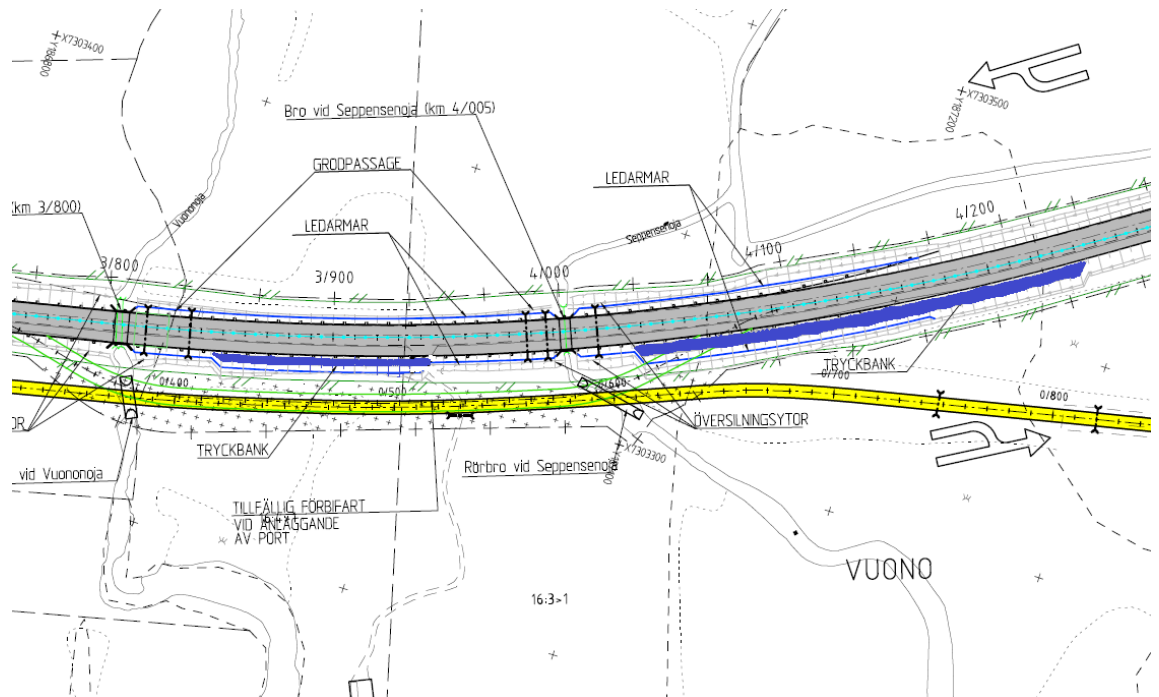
Figuren visar den planerade groddjurspassagen med ledarmar och trummornas placering (blå detaljer i bilden).
